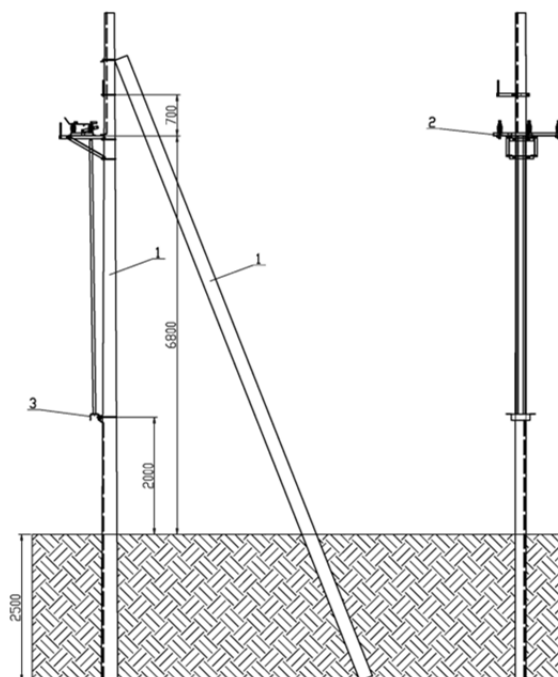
Установка разъединителя. Общий вид.
